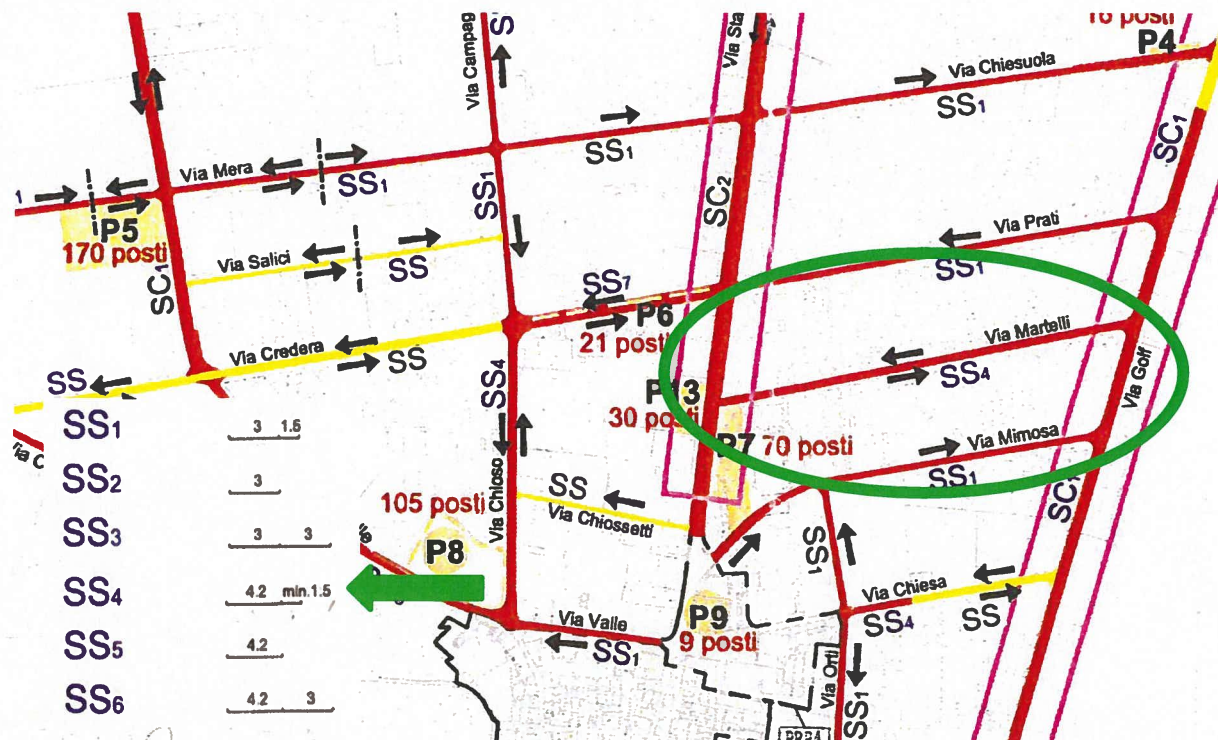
Estratto planimetrico dal Piano Viario di Caslano - Identificazione calibro di via Martelli
